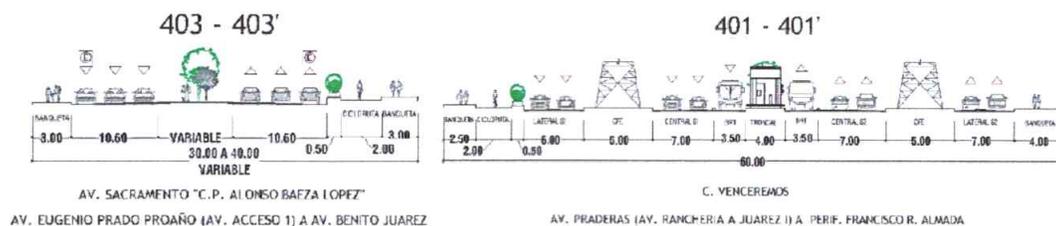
Secciones viales futuras de la Vialidad Sacramento y Av. Venceremos. Fuente PDU 2040 vigente.
